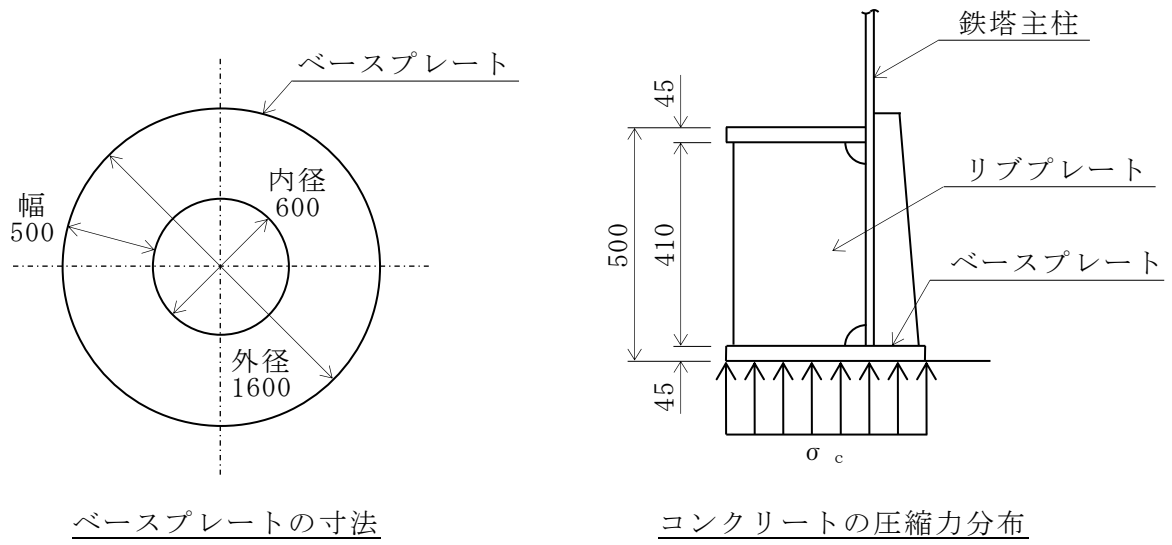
ベースプレートの概要図及びコンクリートの圧縮力分布図（単位：mm）
